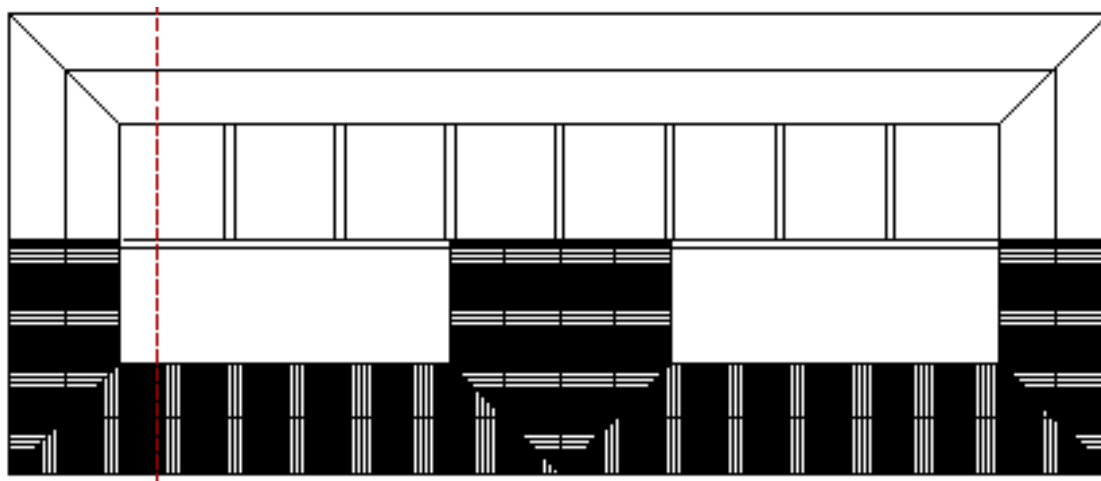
“Planta de Cobertura com marcação do corte – Armazéns.”
